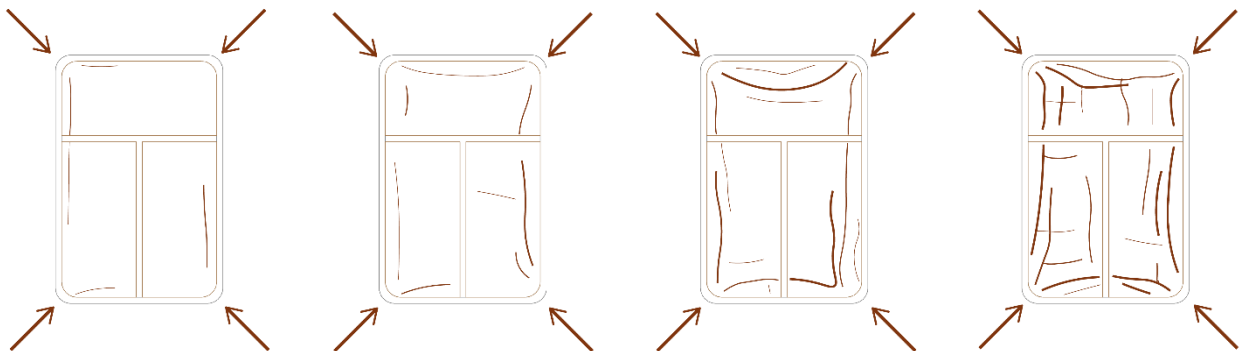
schema del quadro fessurativo previsto in pianta per colonne a base rettangolare (RT FRCM)
